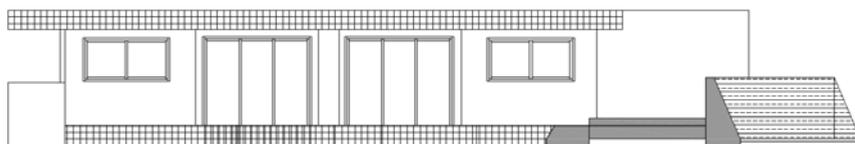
Sección vertical de la fachada Este de la vivienda.
